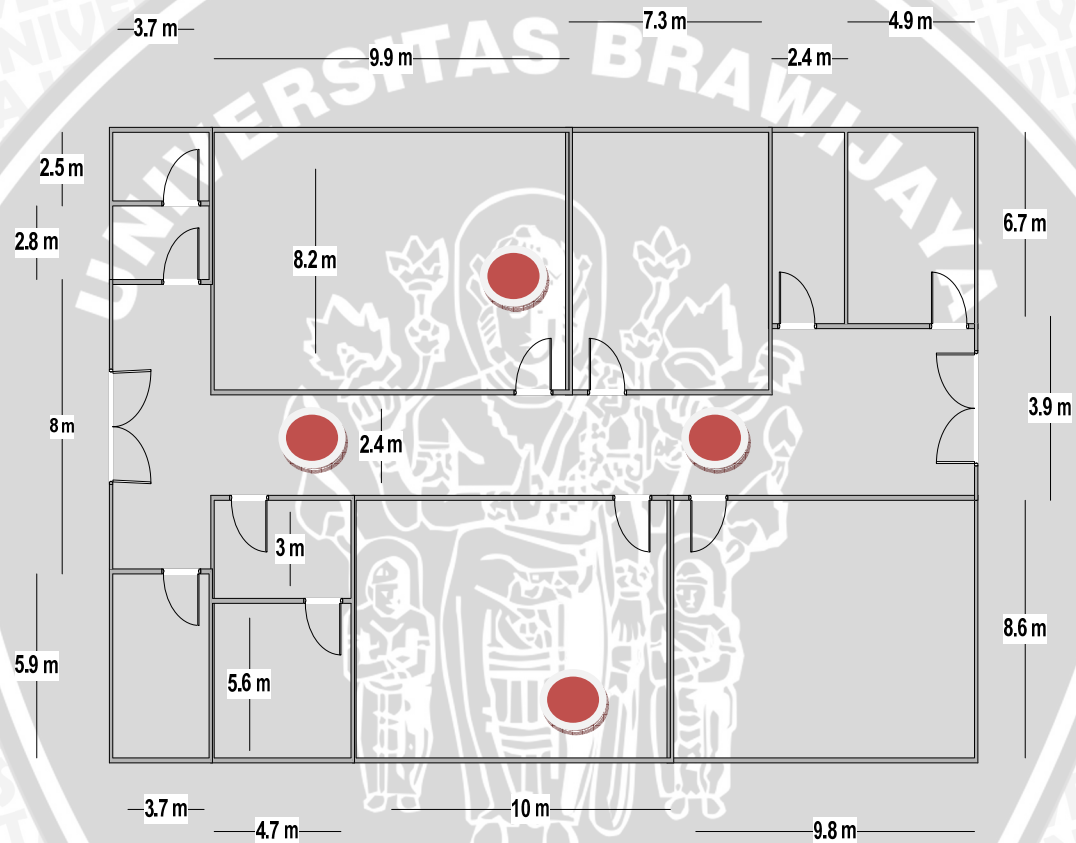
Penempatan AP Gedung A Lantai 2
